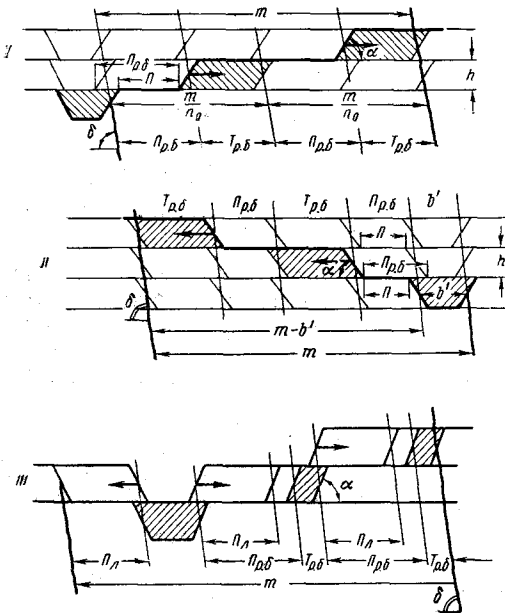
Схемы к системам разработки с продольной подготовкой фронта добычи:
